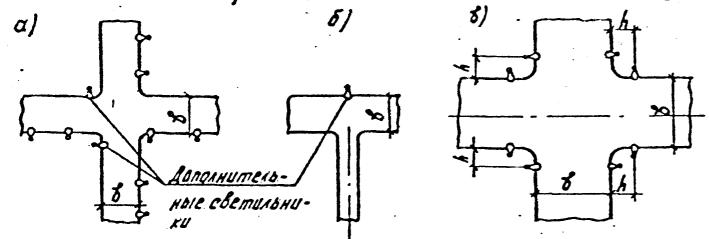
Схены размещения светильников на пересечениях выднам уровне (п-высота светильника)
